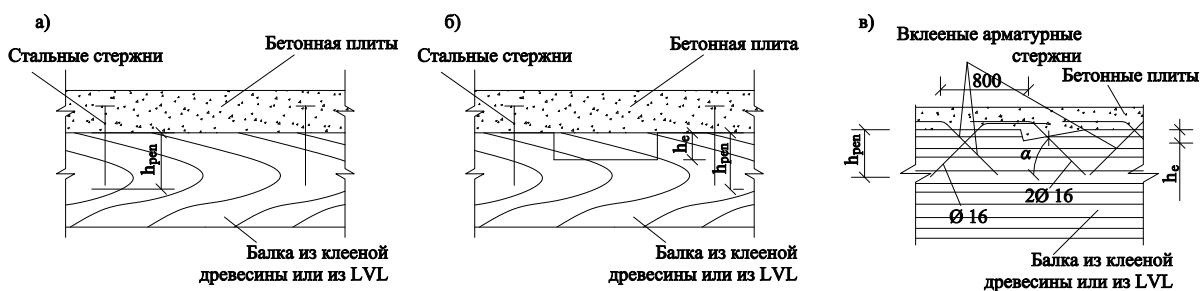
Схемы соединений в дерево-бетонной плите
